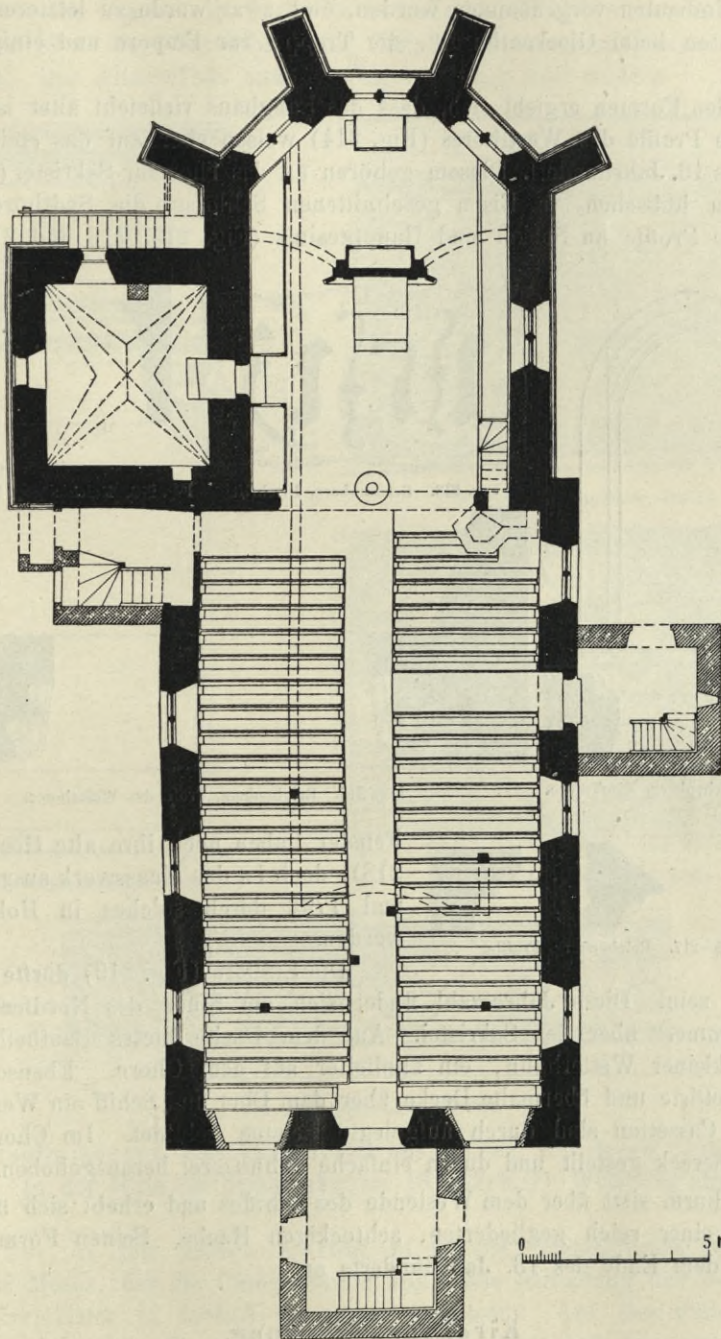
Reichenberg, Grundriss der Kirche.
